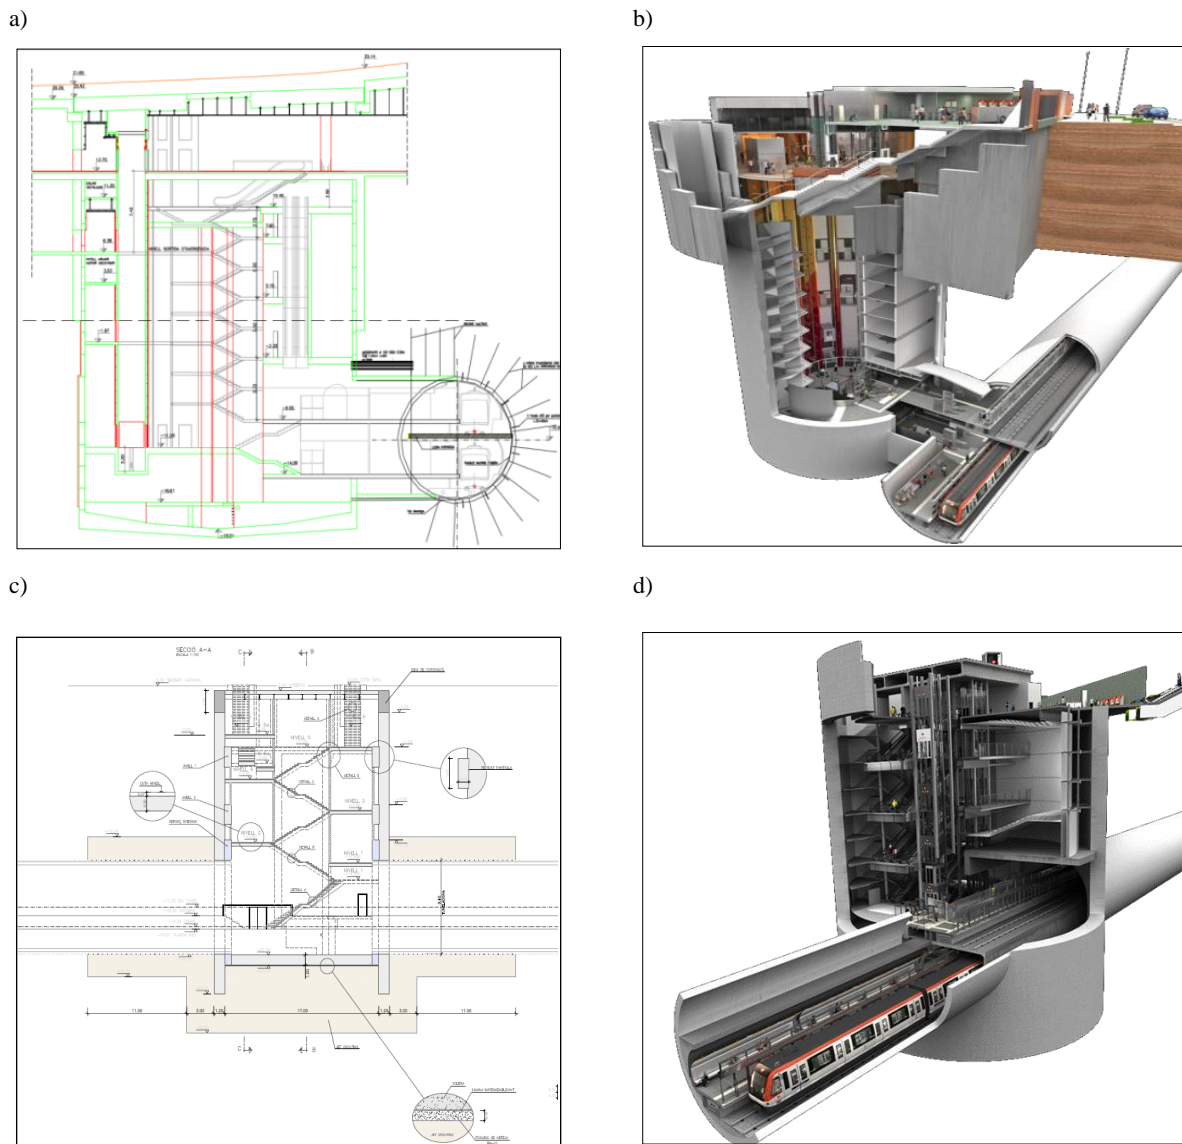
a) Perfil sección transversal de una estación tipo pozo b) Sección en 3D de la estación tipo pozo c) Perfil sección transversal de una estación intersectada por el túnel d) Sección en 3D
